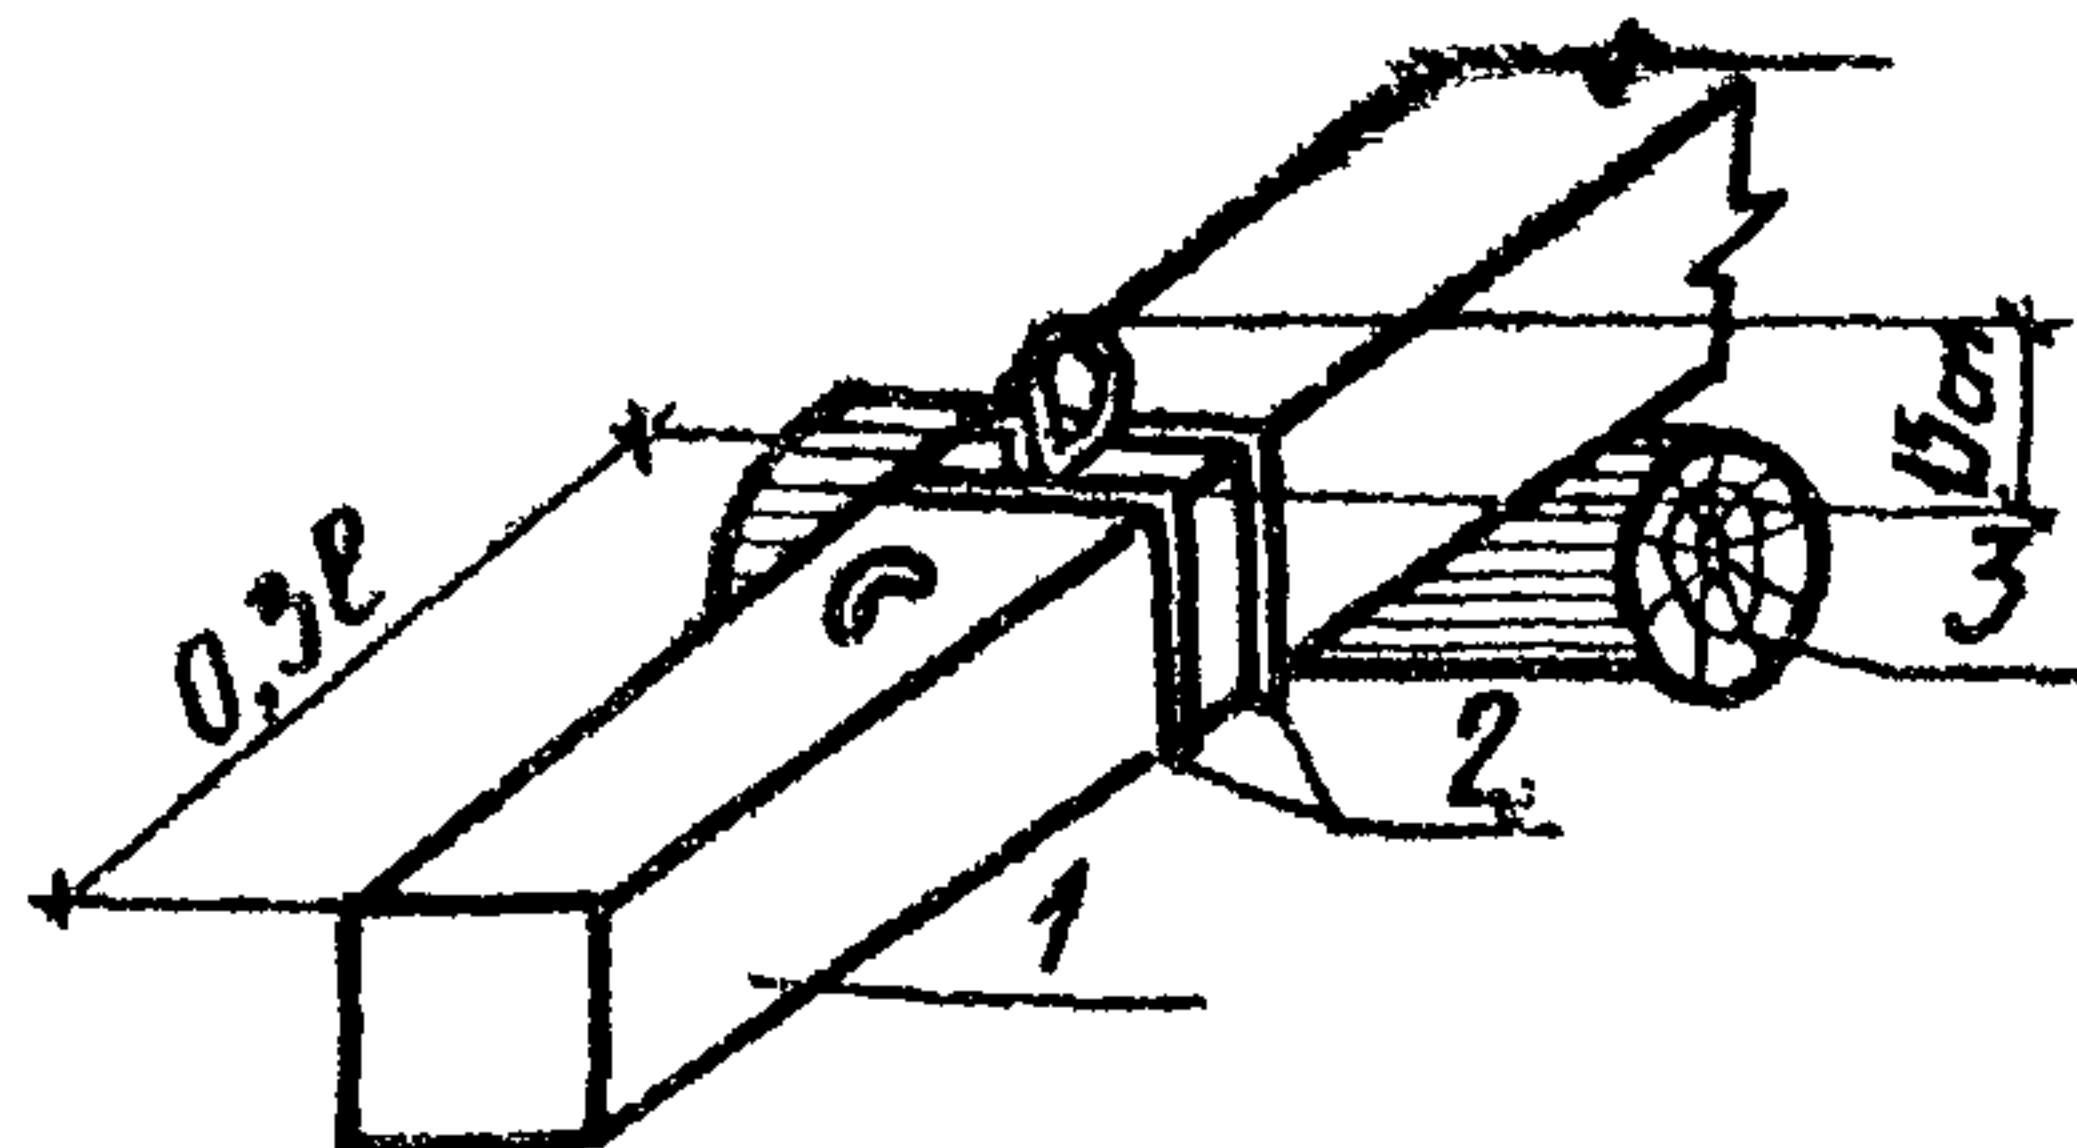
Строповка свай для подъема под наголовник: 1-свая; 2-кольцевой строп; 3-подкладка
